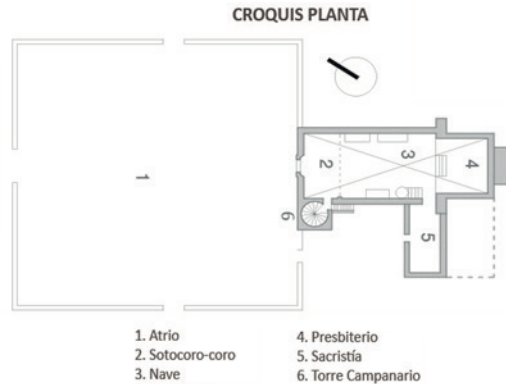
A. Croquis, de planta arquitectónica de Santa María Huatlatlauca, Puebla.
